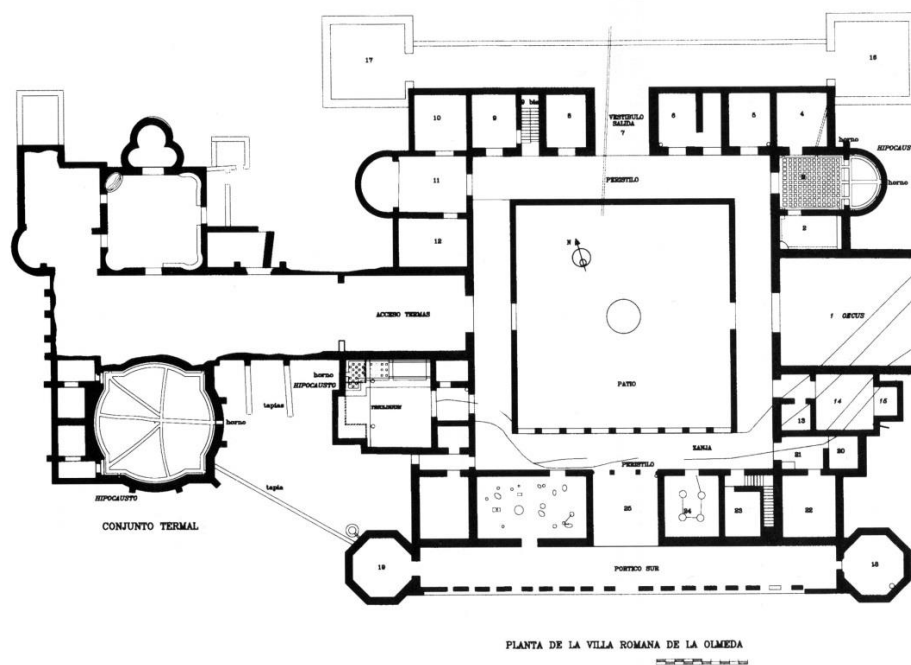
Planimetría de la villa de La Olmeda (Palencia).
